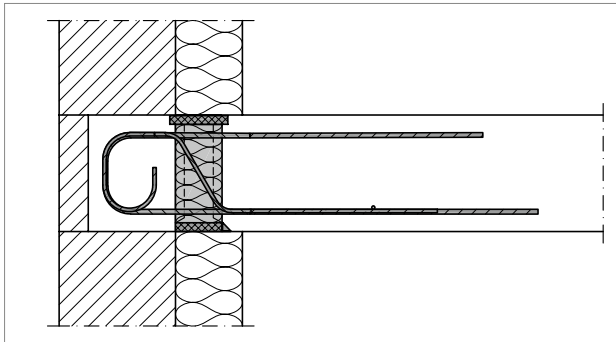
Schöck Rutherma® T type DF*i* : liaison pour façade en maçonnerie et dalle en béton coulé sur place
